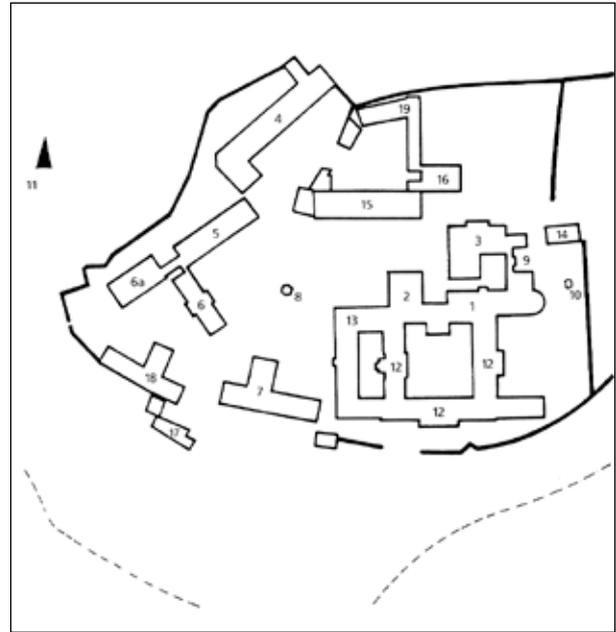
Kloster St. Marienthal, Lageplan der Klosteranlage mit Legende zu den Gebäuden, o.J., Zeichnung
